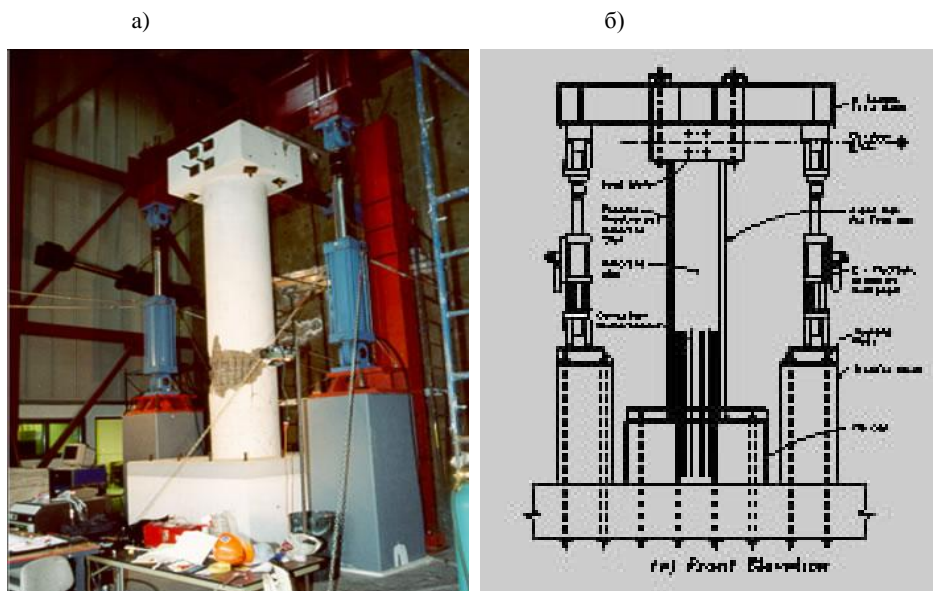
Установка для исследования бетонных столбов на удар с помощью стальной горизонтальной балки. (Department of Structural Engineering, San Diego – США) [308]:
